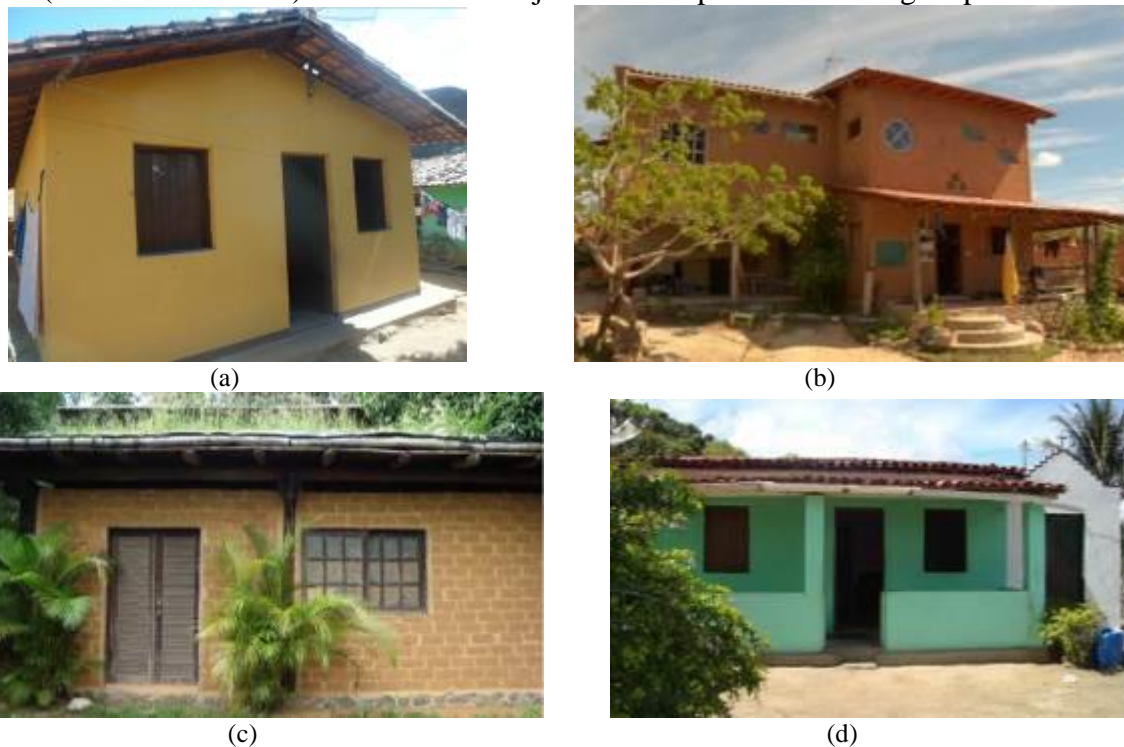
(a) Edificação executada pelo construtor “A” em Banzaê; (b) Edificação executada pelo construtor “B” em Rio de Contas; (c) Edificação executada pelo construtor “C” em Camaçari; (d) Edificação executada pelo construtor “D” em Santa Terezinha
